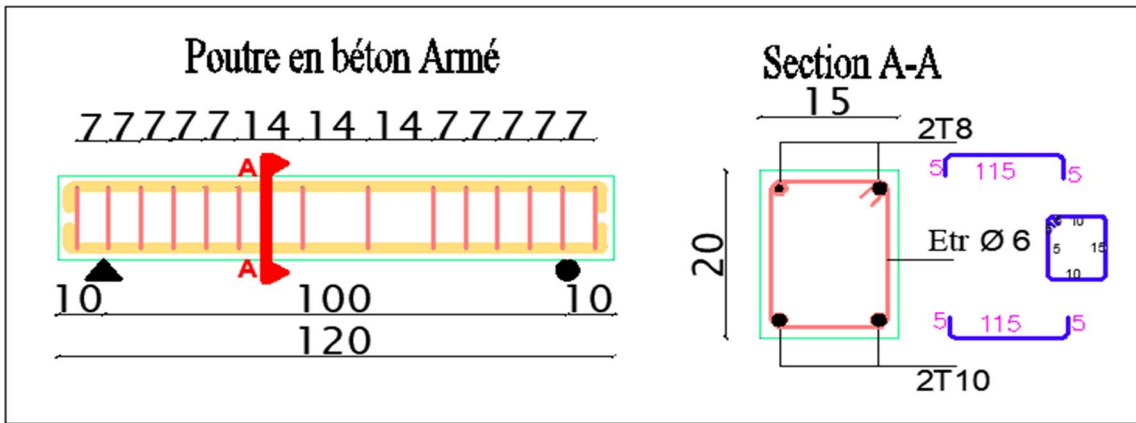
5-Schéma de ferrailage type des poutres de l'étude
